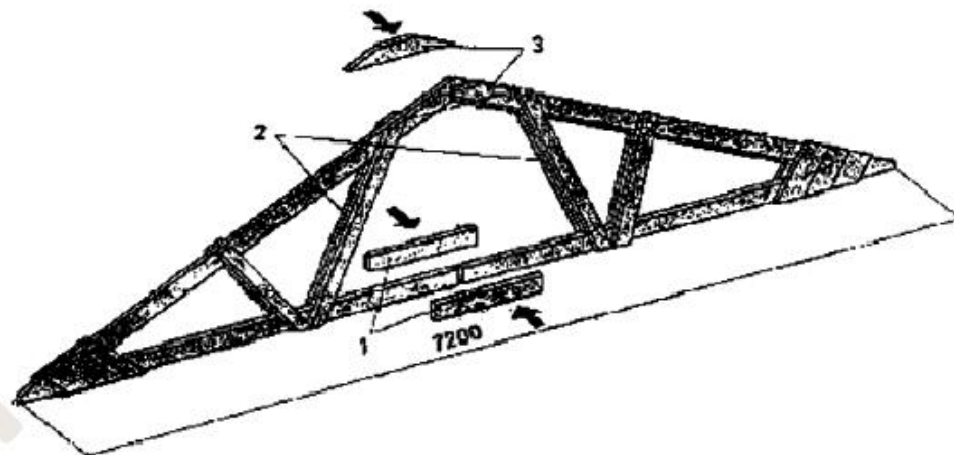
Сборка стропил из двух полуферм 1 - нижние накладки; 2 - полуфермы; 3 - верхние накладки
